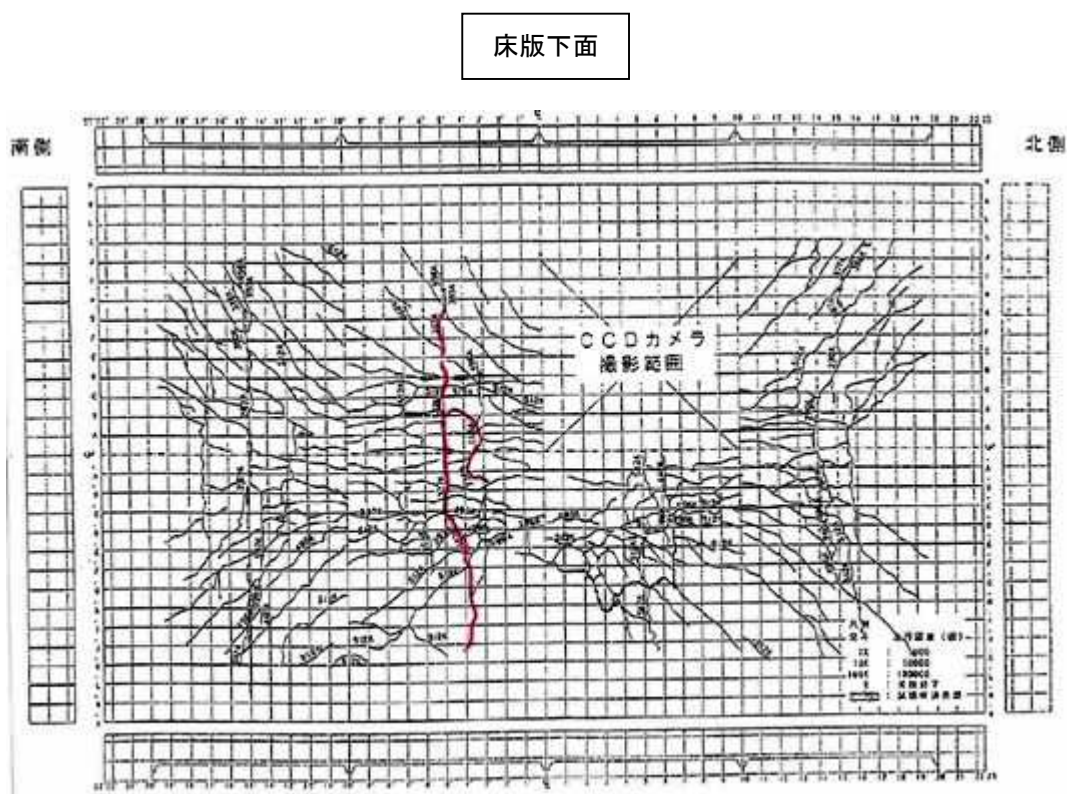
床版下面ひび割れ図 (PC 合成床版供試体 (その 1))
